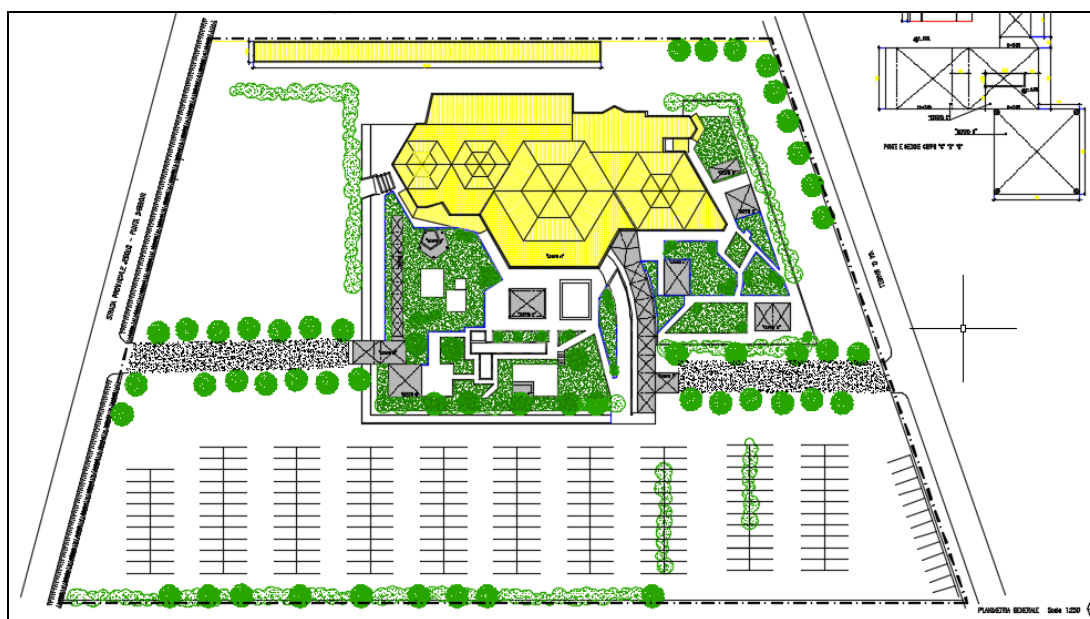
Estratto della Planimetria dello stato di fatto Ambito 2 .
